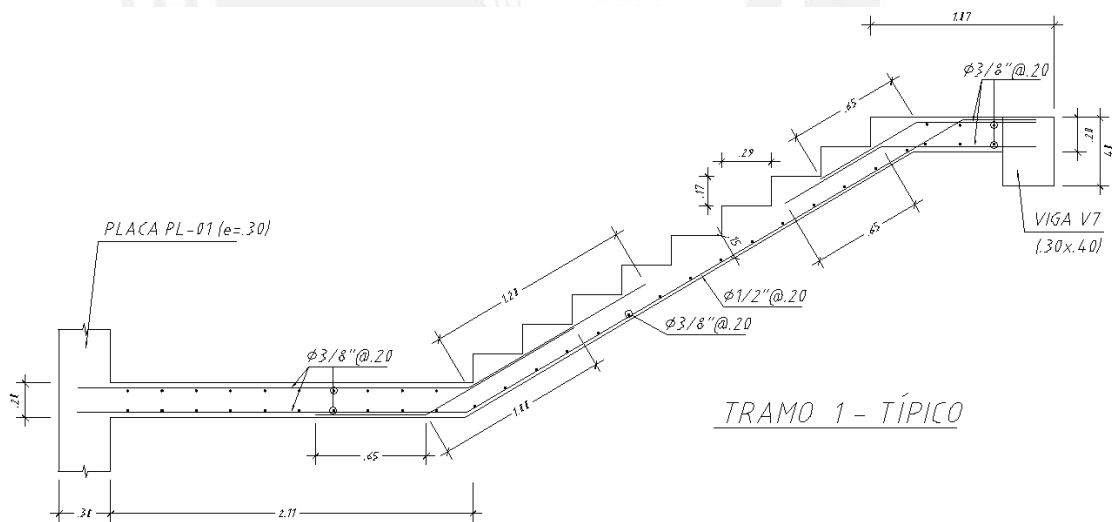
Acero colocado en un tramo 1 típico de la escalera.
